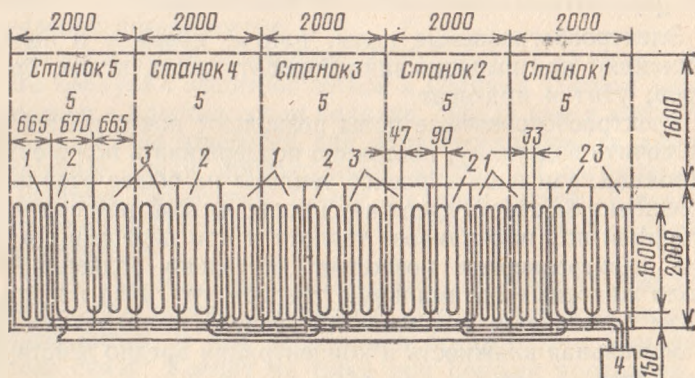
Схема размещения нагревательного провода для обогрева пола в свиарнике:
